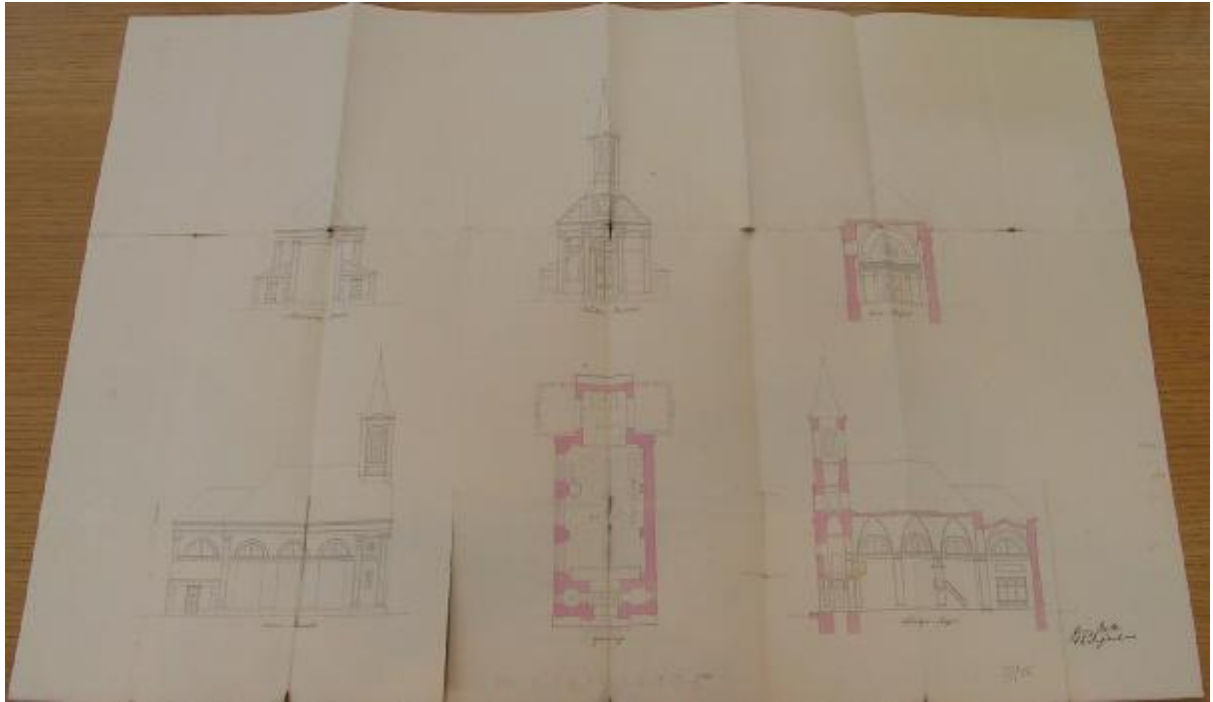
Plan zum Neubau der Pfarrkirche Altmannsdorf, Franz Lößl, 1838;
